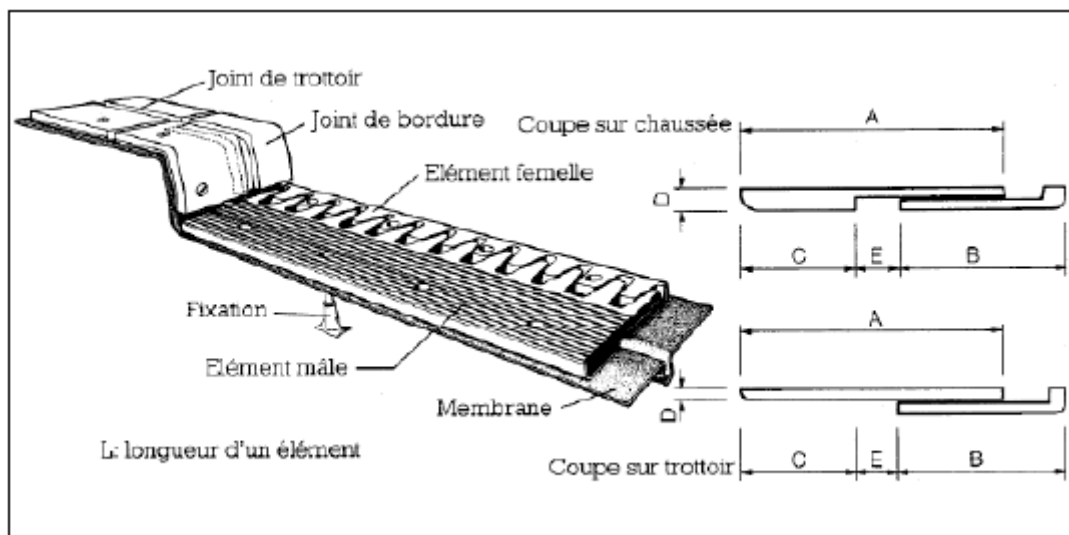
joint de chaussée type FT150 (Freyssinet)
